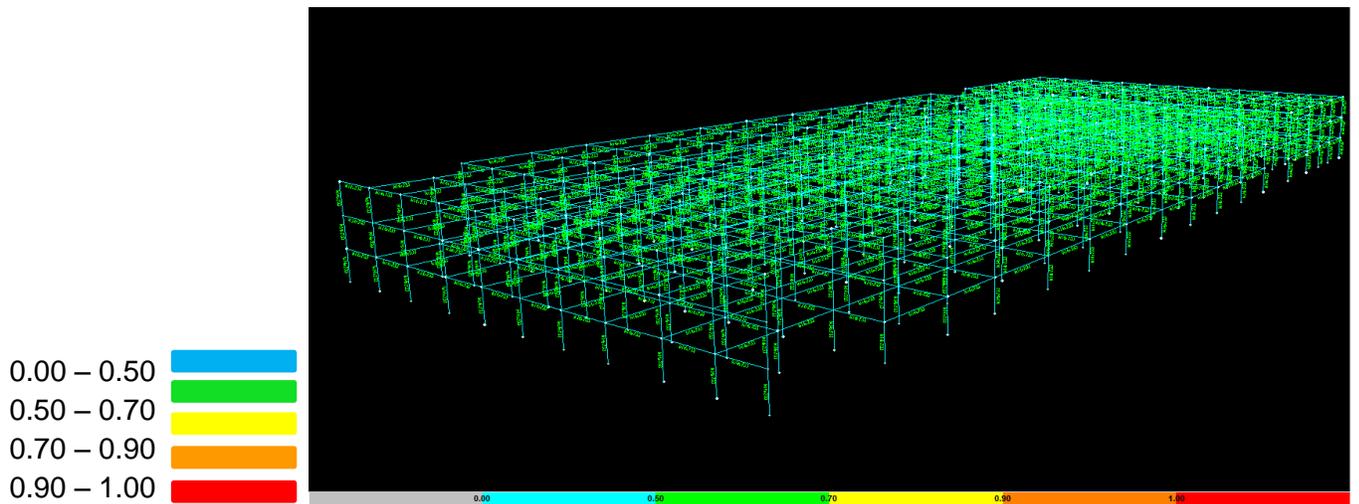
3D de la estructura con los perfiles correspondiente
